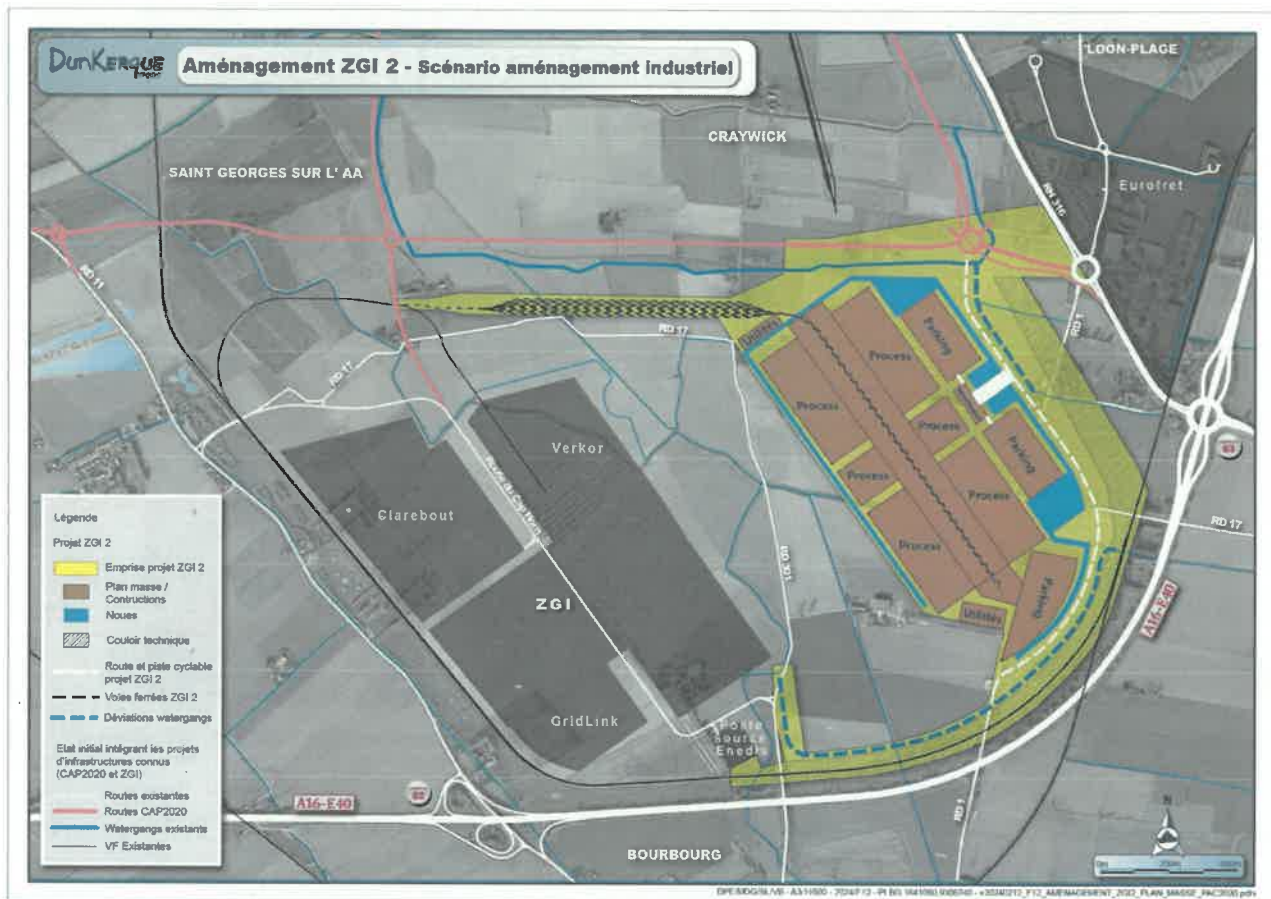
Plan de situation zoomé sur l'emprise projet (Source fond : GPMD 2023)
